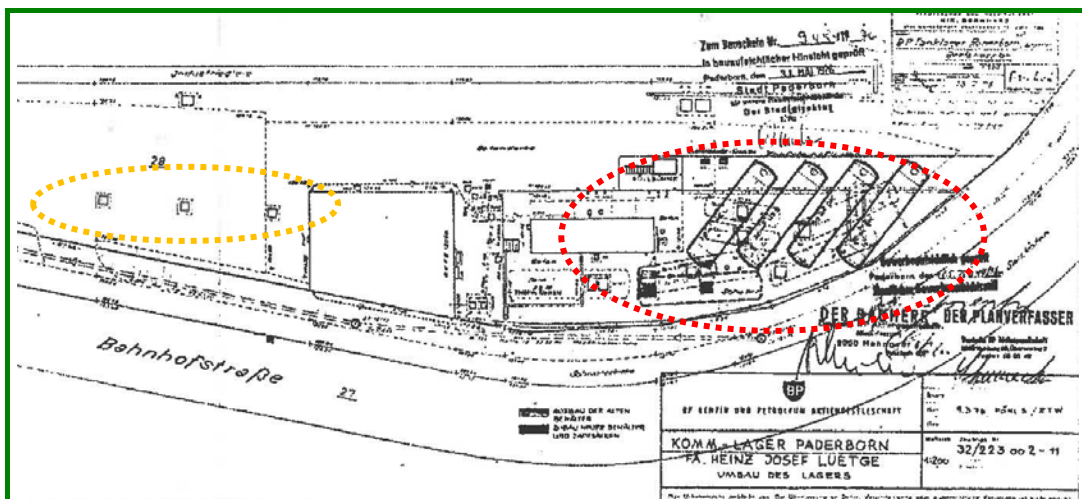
Lageplan aus 1976; rote Markierung: Rückbau Alt-Tanks/Neubau Neutanks
